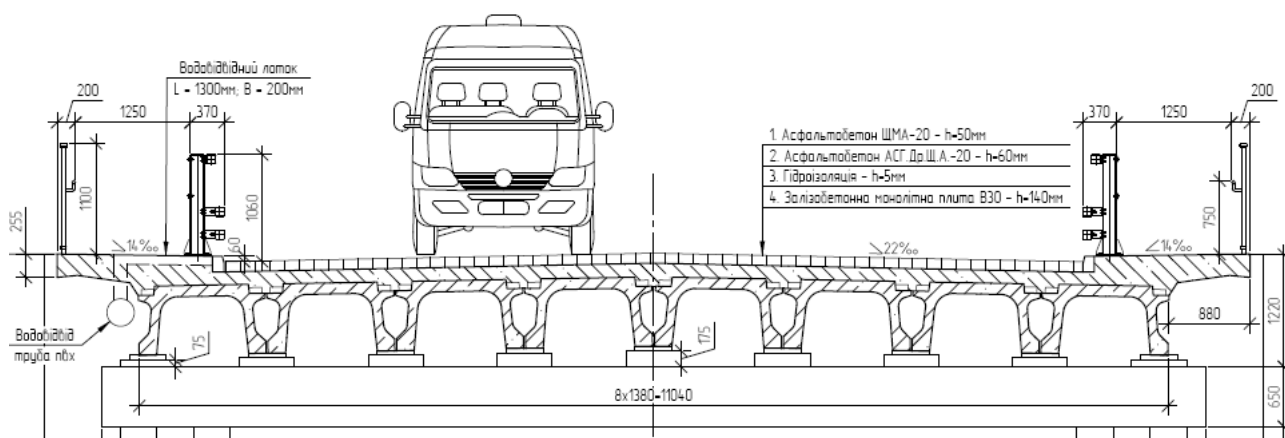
Поперечний переріз автодорожнього мосту із схемою завантаження залізобетонної плити прогонової будови
